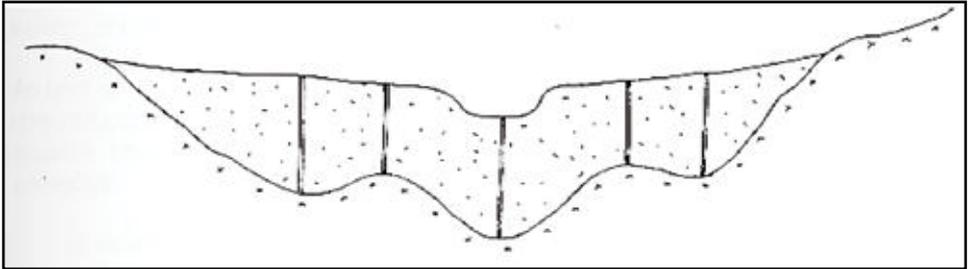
Disposição dos Furos [Vista em Seção Vertical]
